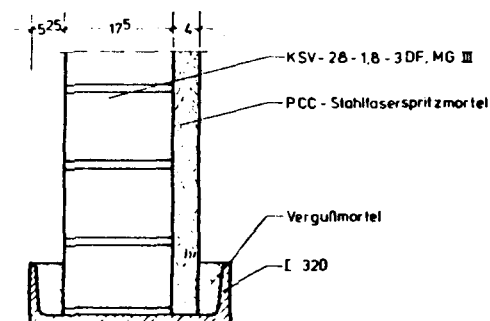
Mauerwerkswand, deren Biegebewehrung durch Vermörtelung endverankert wurde
